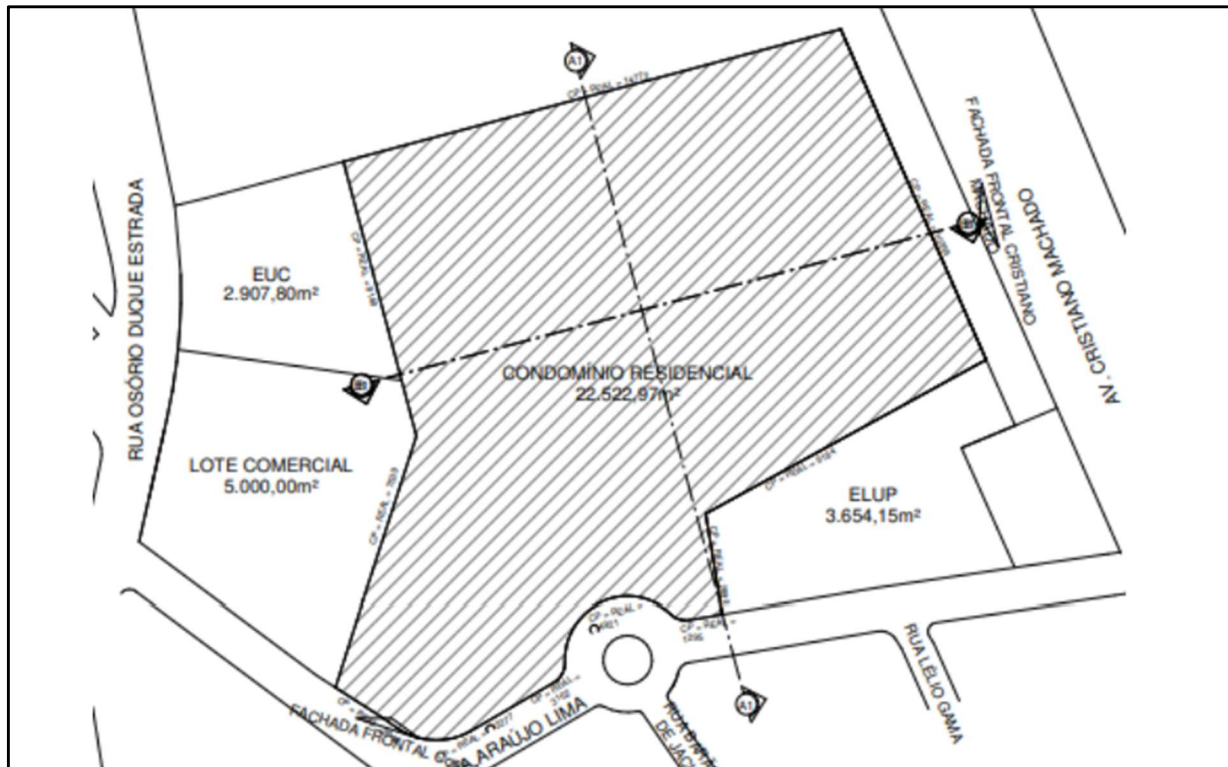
Disposição dos lotes distribuídos na gleba. Fonte: recorte de planta de localização, disponível em pág. 11 do anexo "SARANA-Anexo5_ProjArq.pdf" em ticket BHDigital 31.00654616/2024-75.
